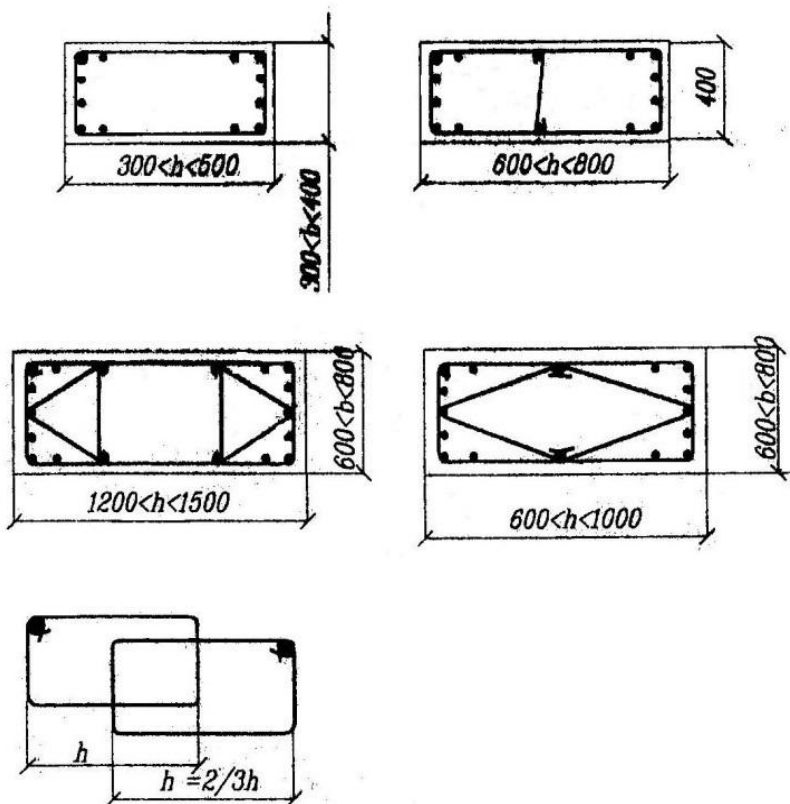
Примеры армирования сечений колонн с рекомендуемым количеством стержней вязаными каркасами
